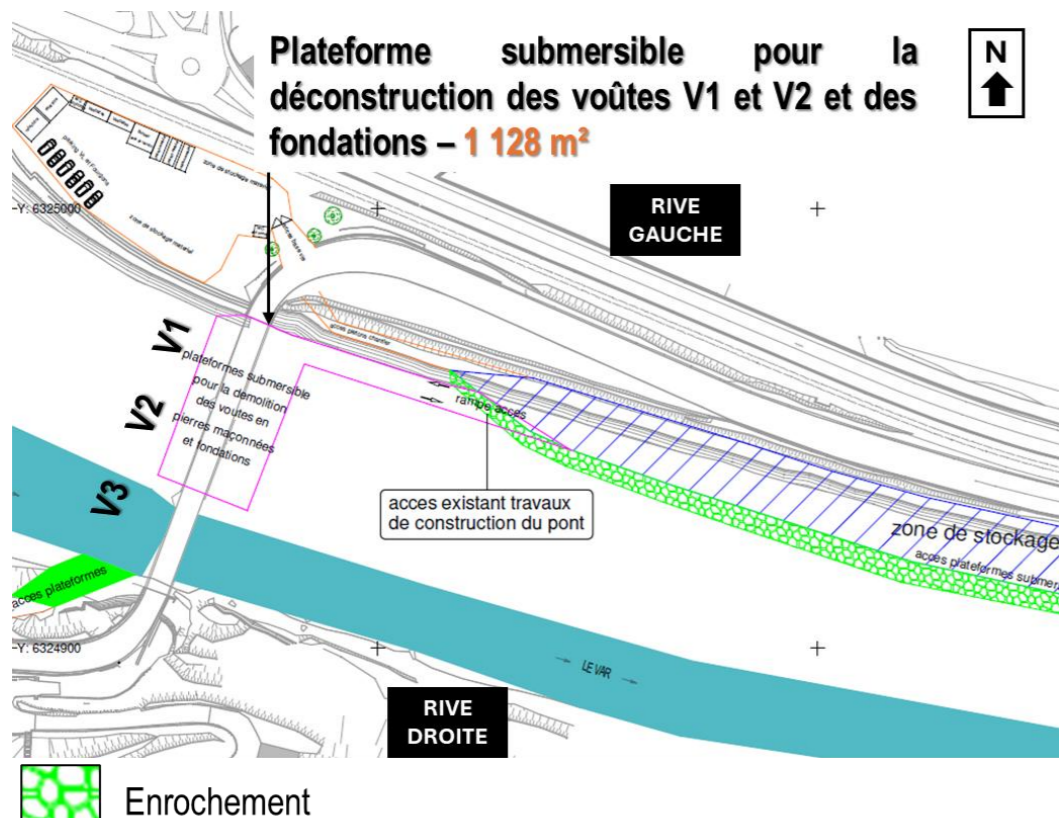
Installations de chantier pour la déconstruction du pont existant
